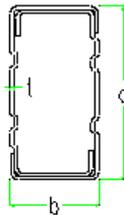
Geometría de Viga "O" 2"x6"x2.0mm
